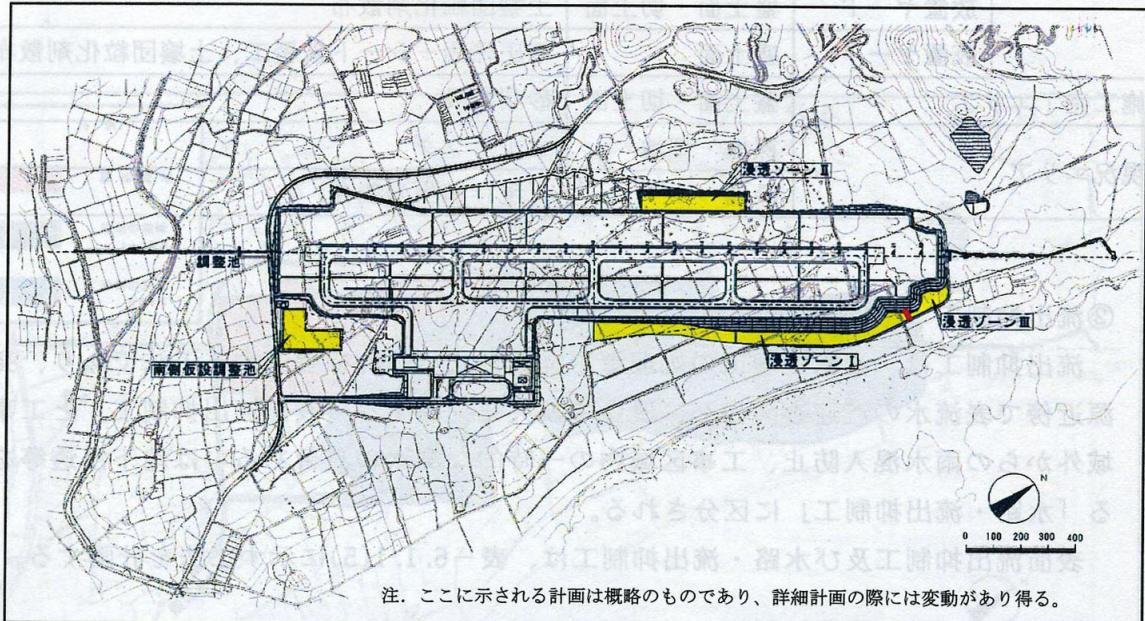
(7) 浸透ゾーン及び南側仮設調整池位置平面図
